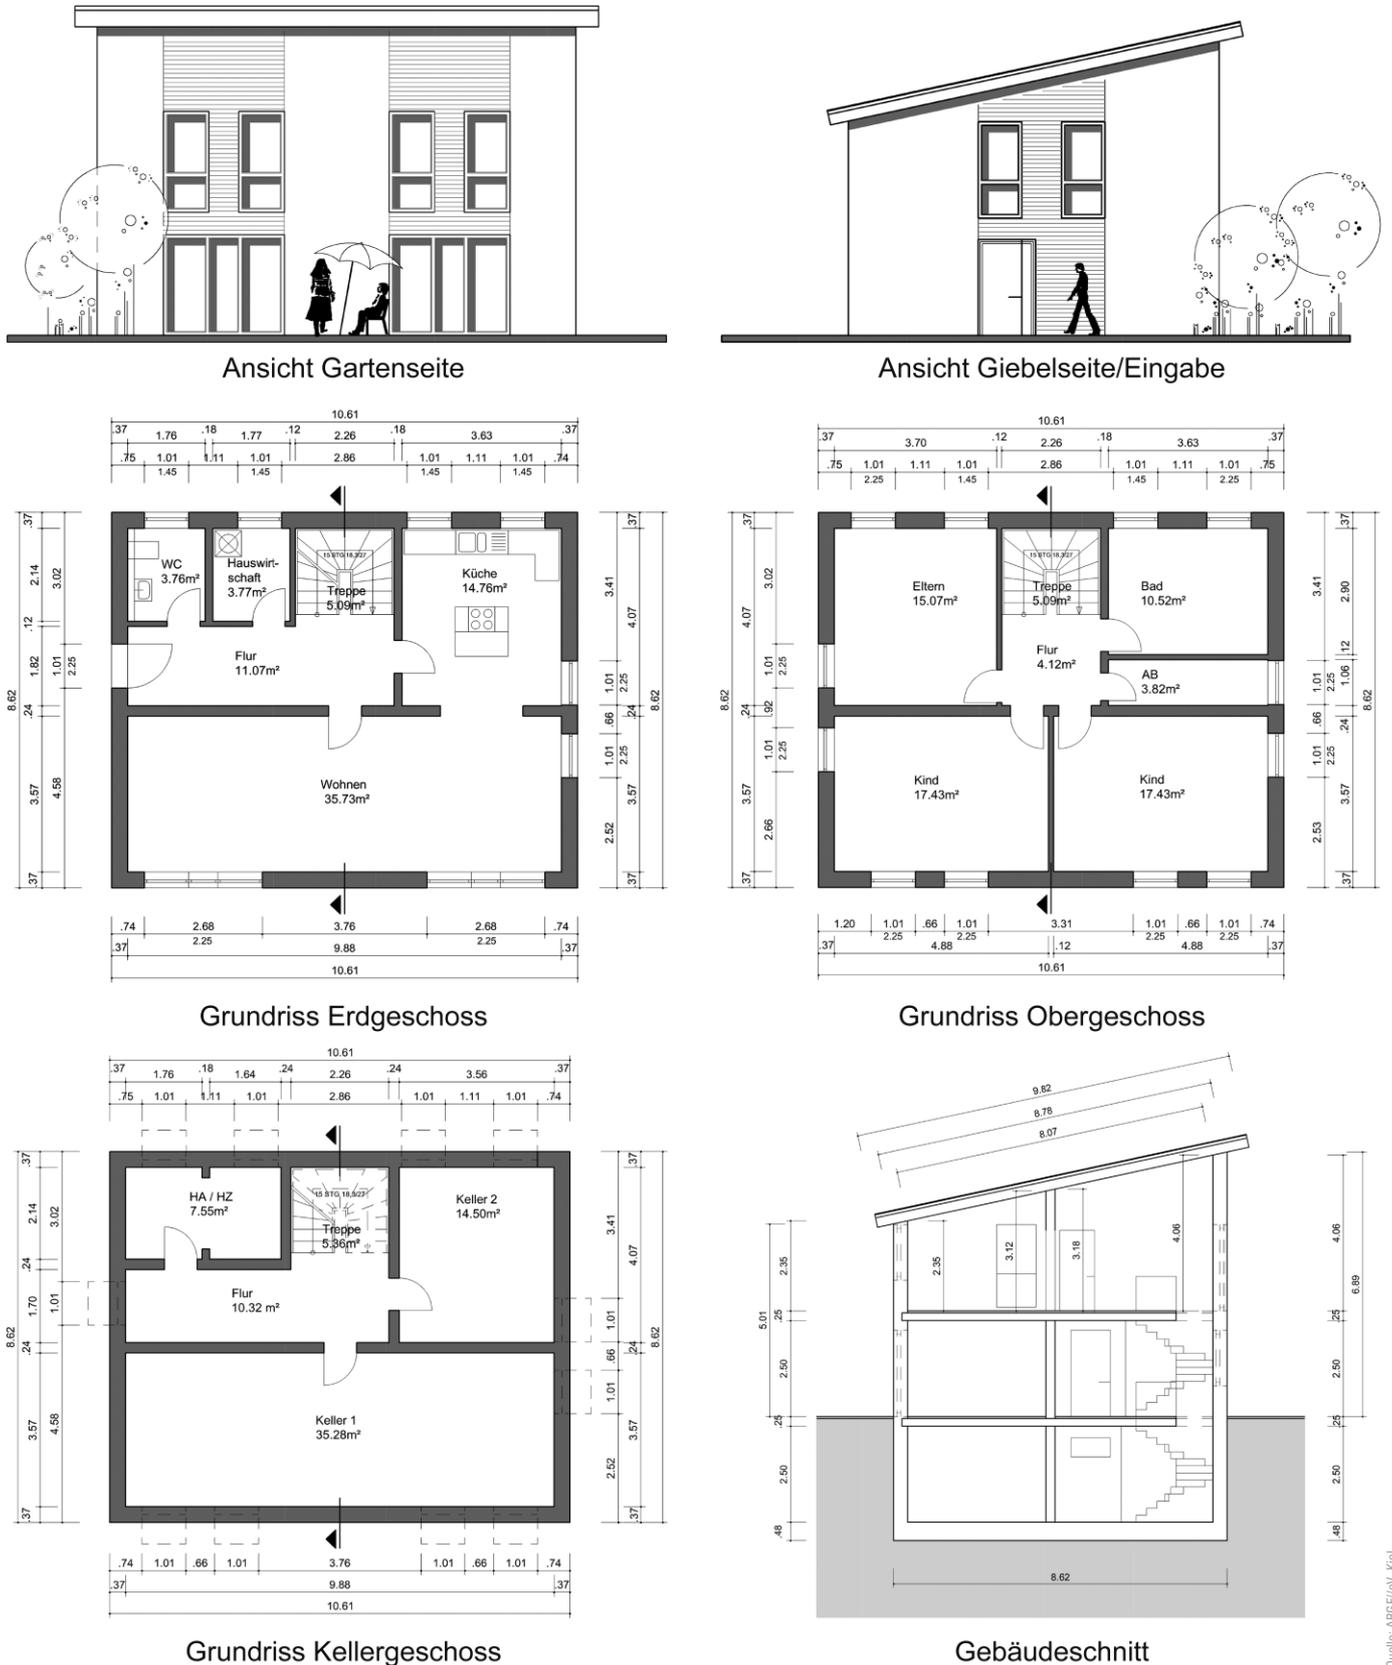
Ansichten und Grundrisse des Typengebäudes der Arge Kiel e.V. – Orientierung des Eingangs: Osten
